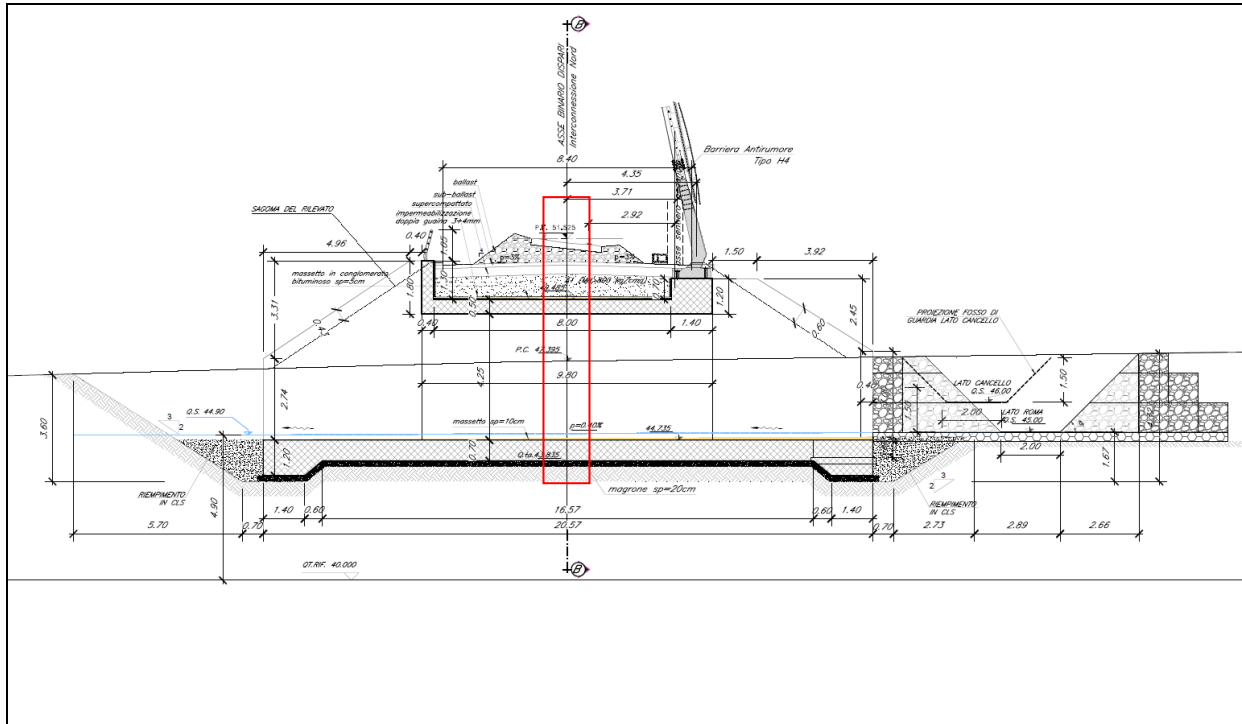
Sezione longitudinale e individuazione delle sezioni SC1 oggetto di verifica.
